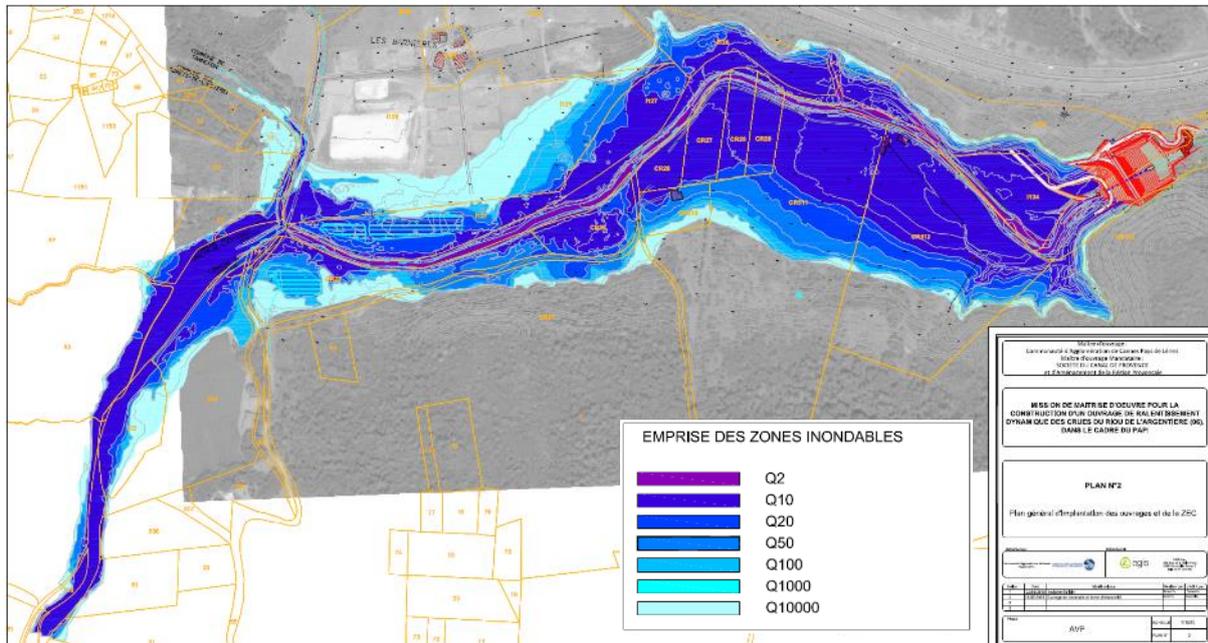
Plan d'implantation général des ouvrages et de la ZEC
